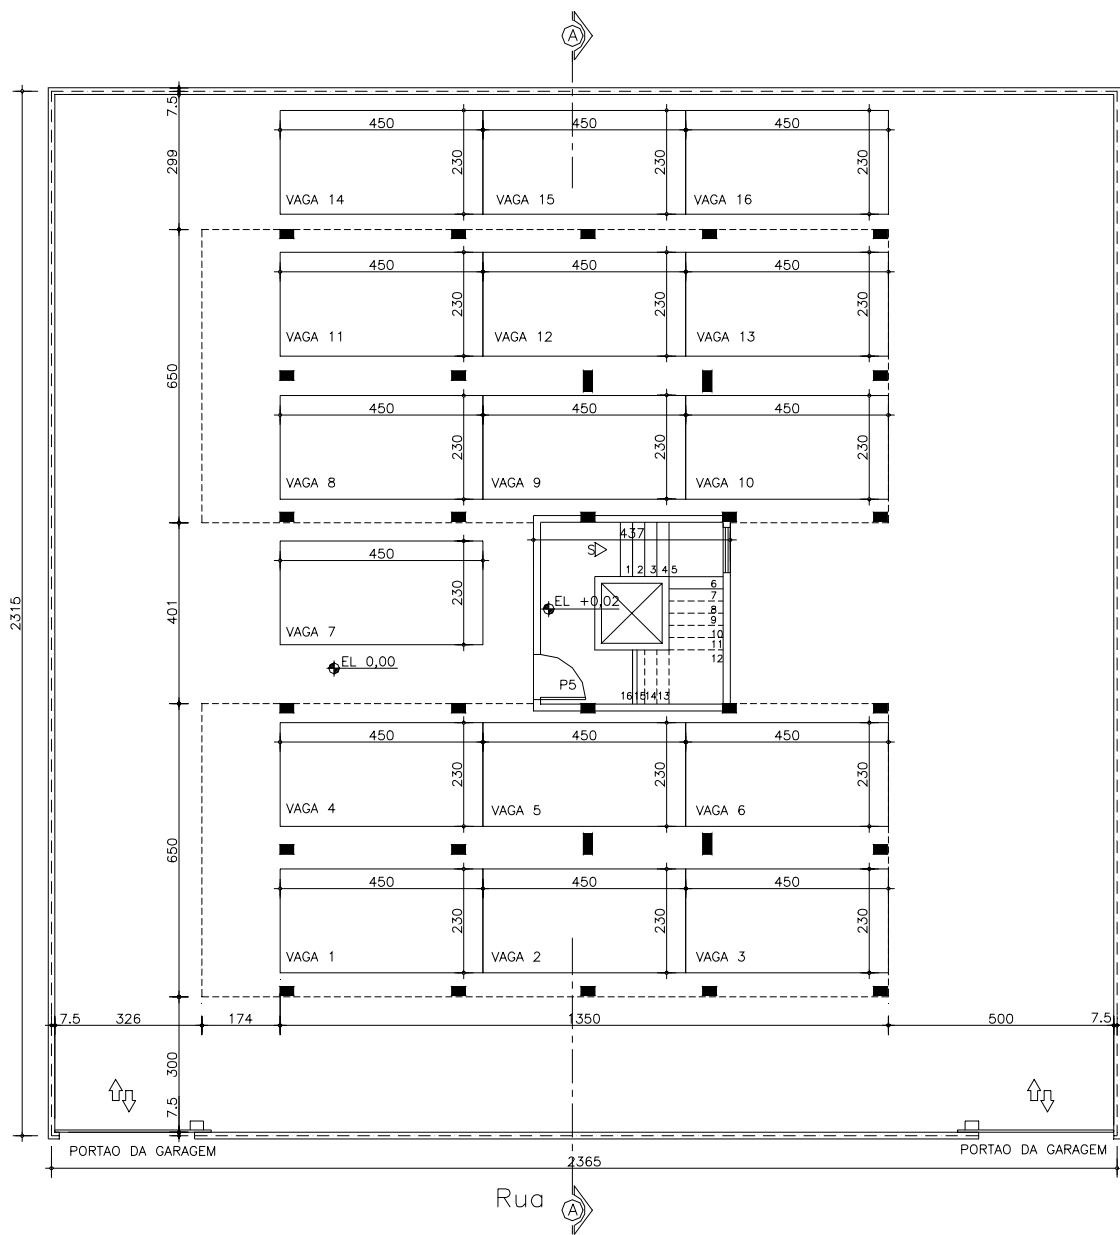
Prédio “A” – Opção 2 – Planta da garagem
